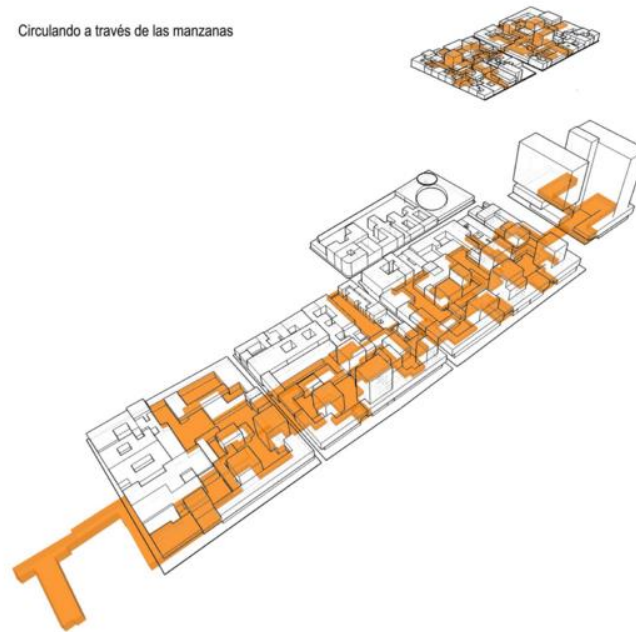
Circulaciones propuestas del proyecto Ministerios; Fuente: Plataforma arquitectura
